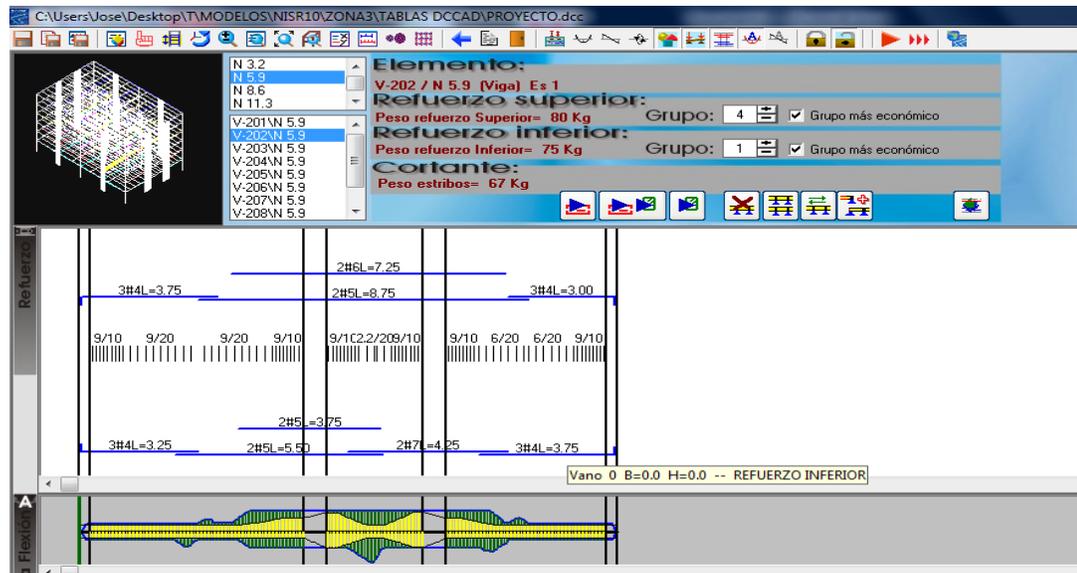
DCCAD 2010. Cálculo de acero de refuerzo
